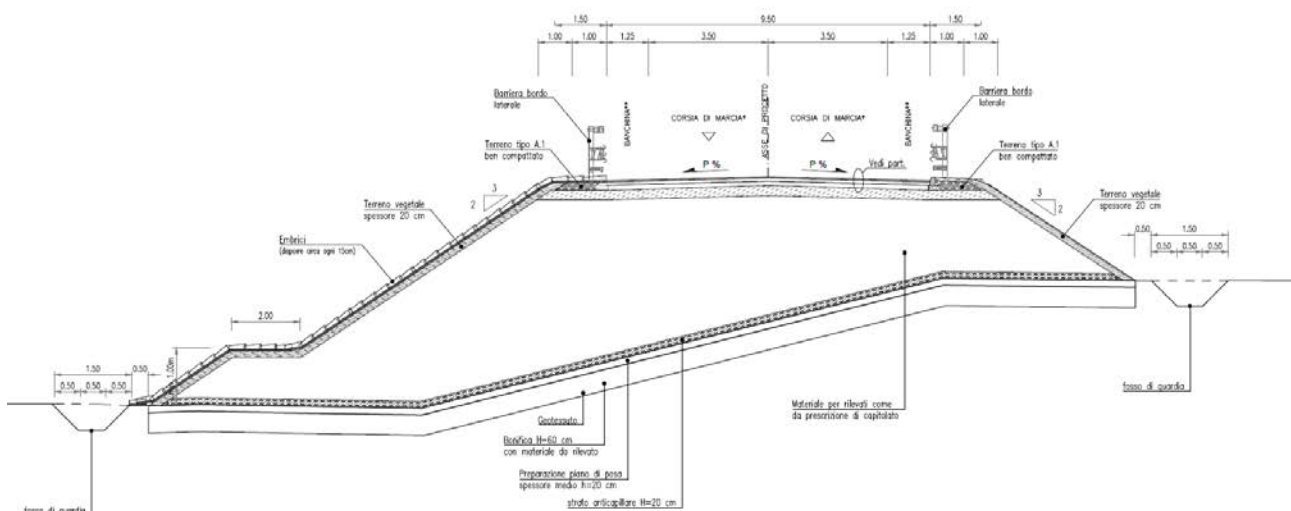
Sezione Tipo Ramo di svincolo in rettilineo – cat C2
